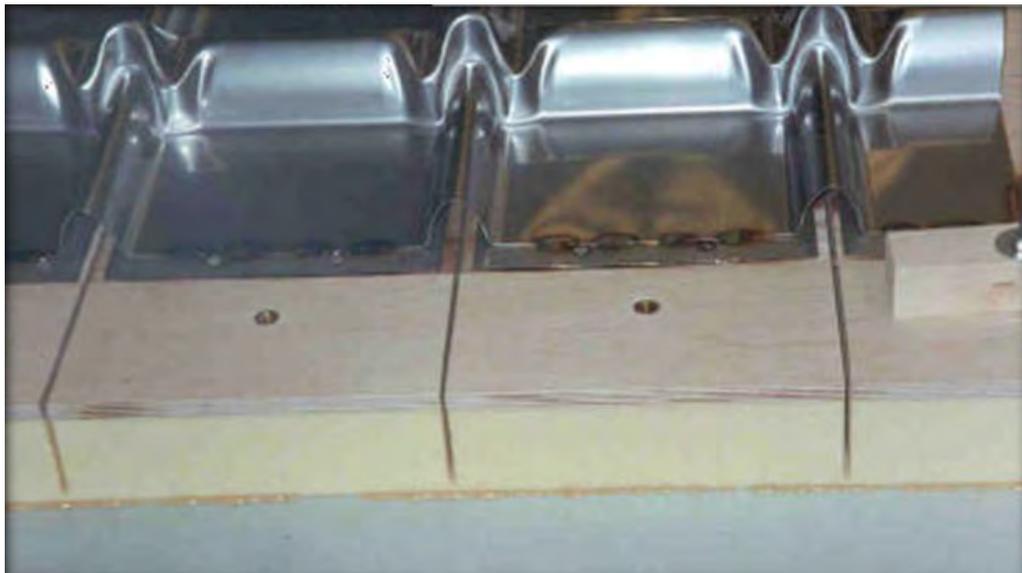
Detalle de la barrera primaria a la capa aislante. Fuente: GTT
